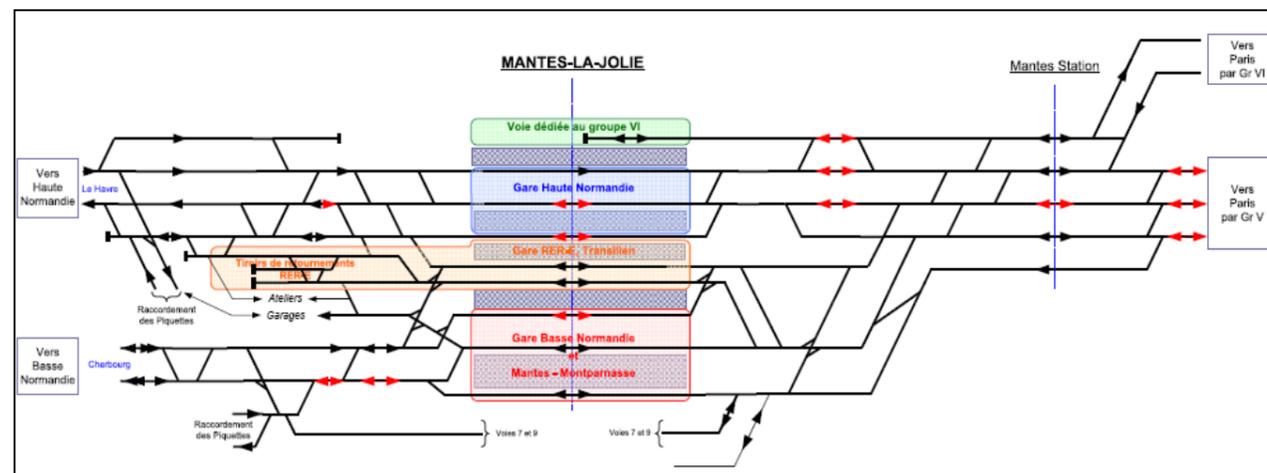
Plan de réorganisation des plans de voies de la gare de Mantes –LA Jolie Gare d'Evangile/Rosa Park en 2020
